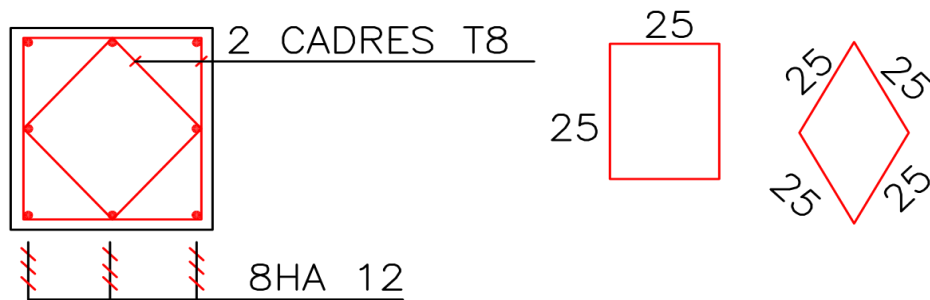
Coupe de ferrailage des poteaux 30×30 cm²
